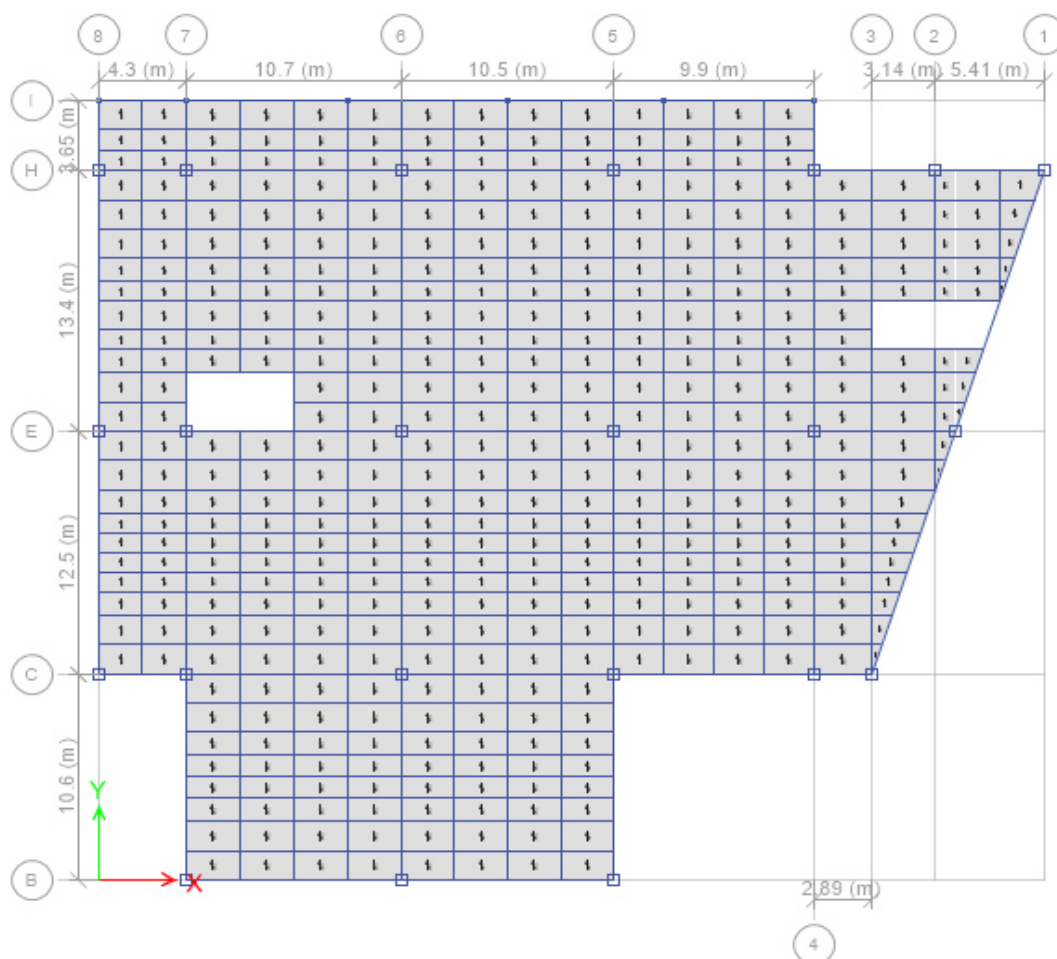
Distribución de ejes en planta del piso 2 (9.88 m).
